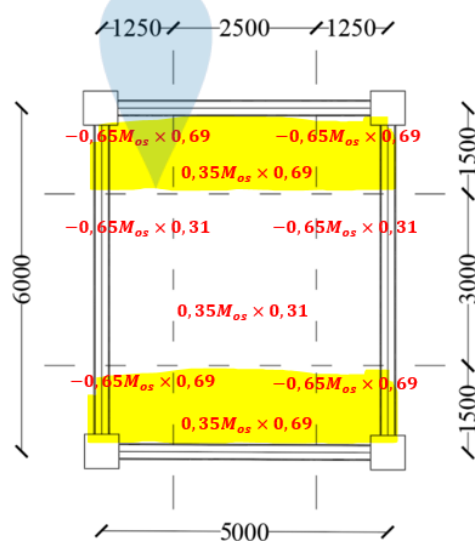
Pembagian Lajur Pada Pelat Arah Memendek
